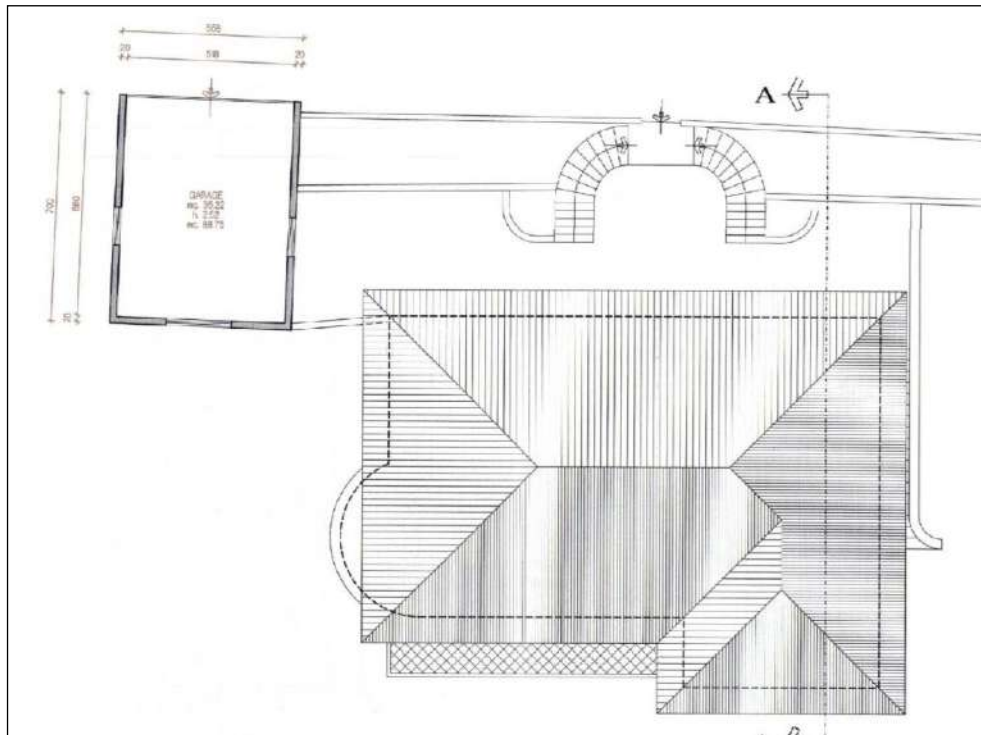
b. Stato approvato autorimessa mappale 195 sub. 2: Pianta Piano Terra.
